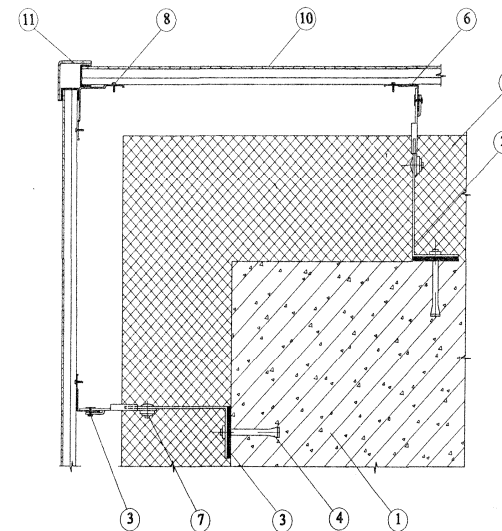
Облицовка наружного угла здания панелями «КраспанМеталл-Стоун»
